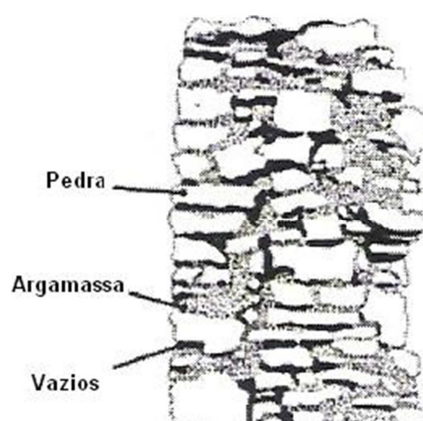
Constituição típica de uma parede de alvenaria de pedra [28]
